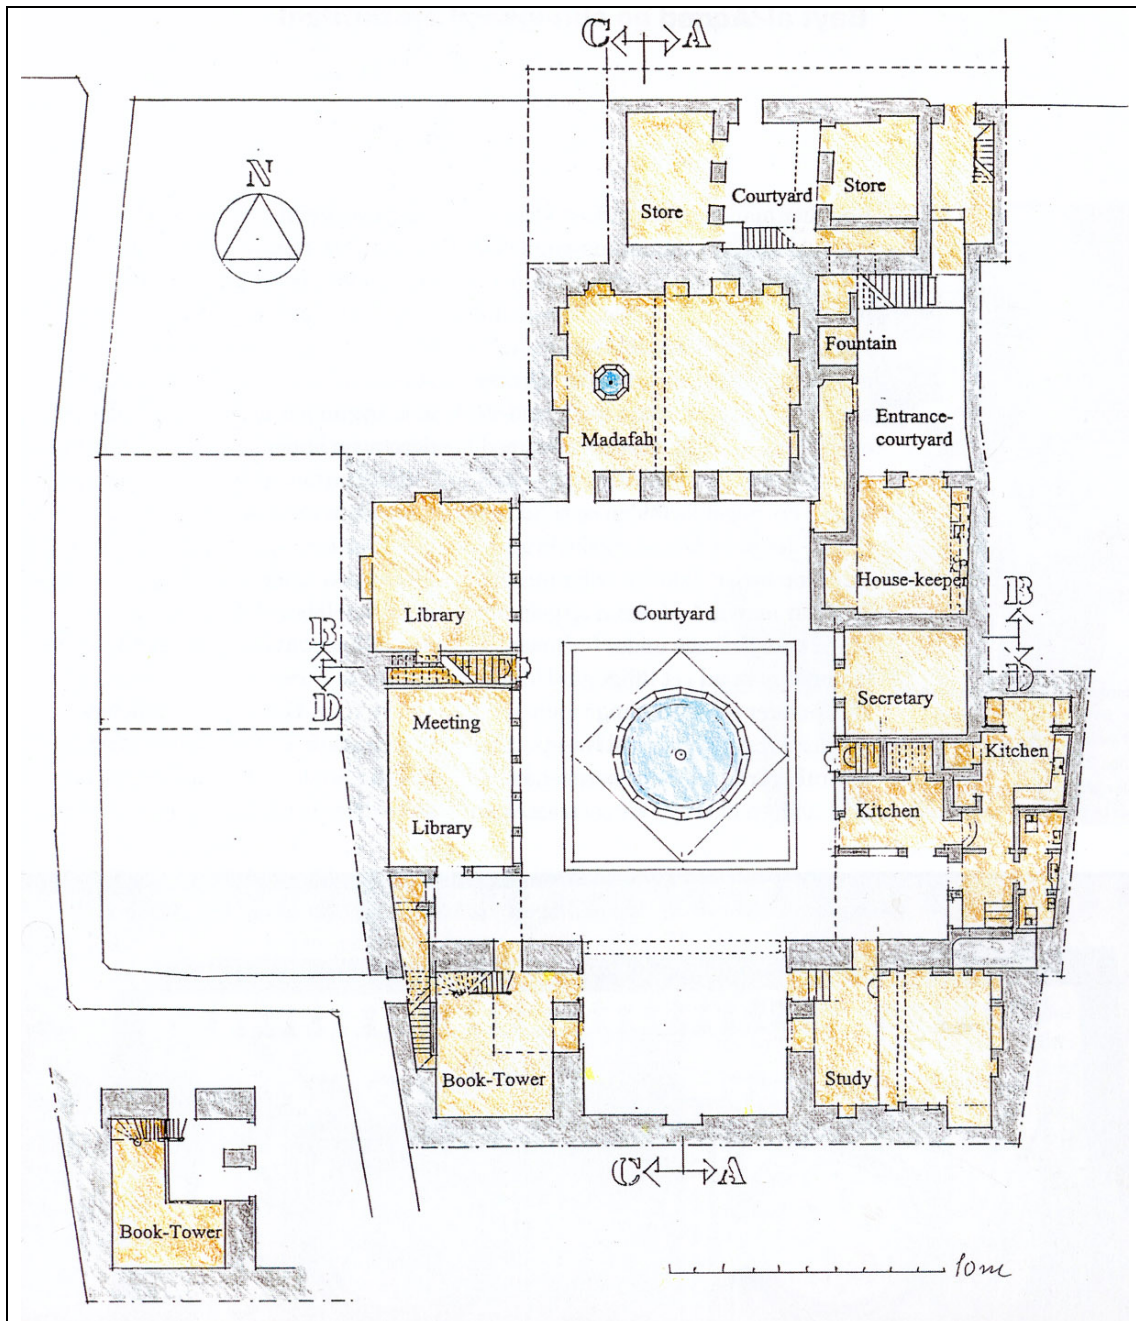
Grundriss des Aqqad-Hauses
